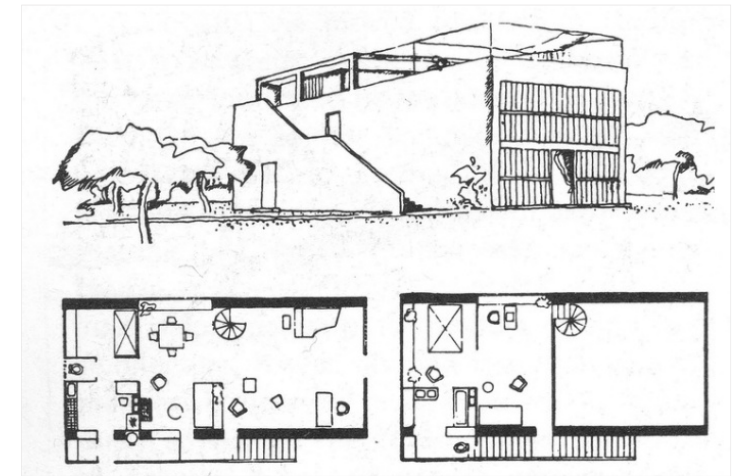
Perspectiva e Planta Baixa do primeiro e segundo pavimento. Primeira Versão da Casa Citrohan. Fonte: Frampton, 2003 pg. 185.
